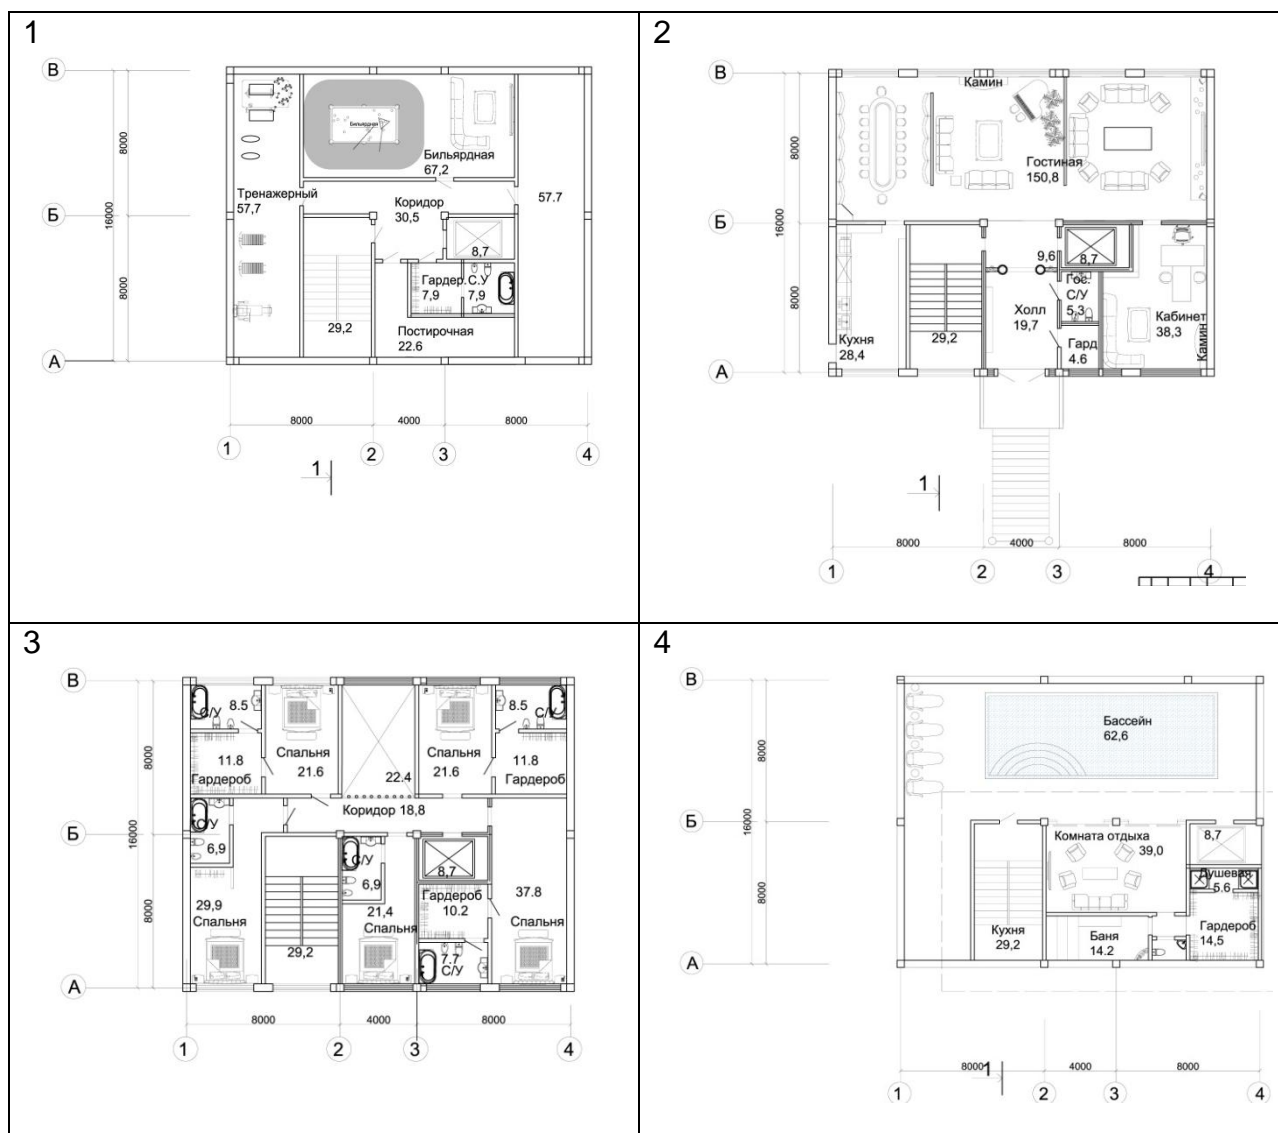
Малый коттедж, г.Алматы, «Европолис» (проект): 1- План подвала; 2 – План первого этажа; 3- План второго этажа; 4 – План эксплуатируемой кровли [материалы компании «Европолис»].
